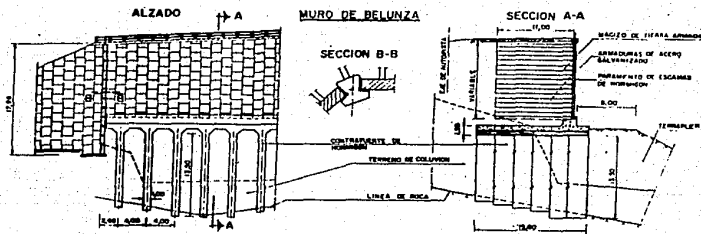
Utilización en carreteras y autopistas de montaña II.
